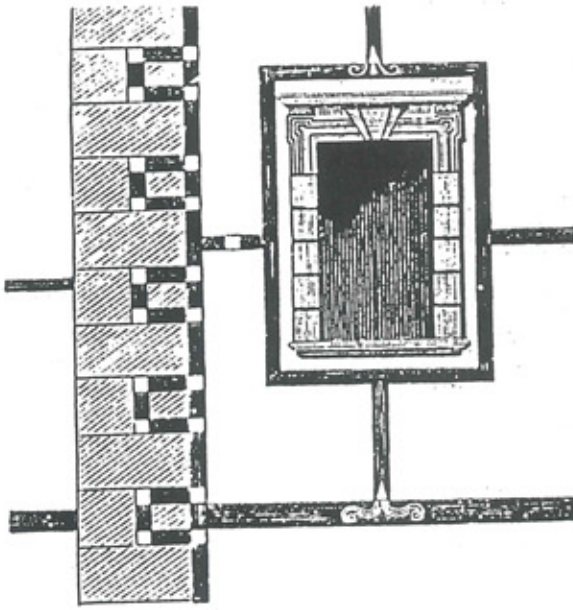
Rekonstrukcja dekoracji sgraffitowej o układzie ramowym na elewacji pałacu w Starej Kraśnicy
